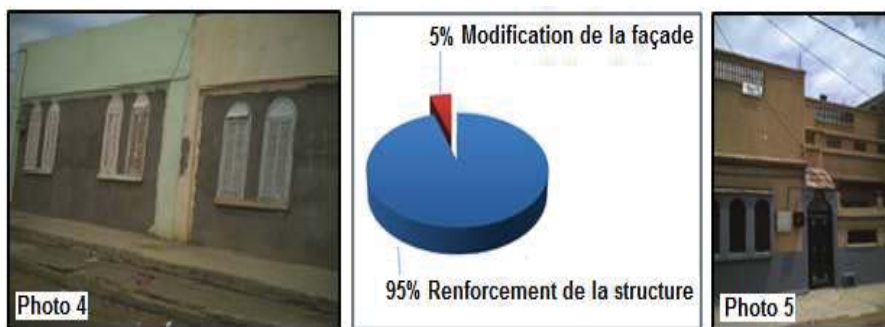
Taux des modifications adoptées Photo. 04 : Renforcement de la structure et rajout du crépissage ; Photo. 05 : modification de la façade.
